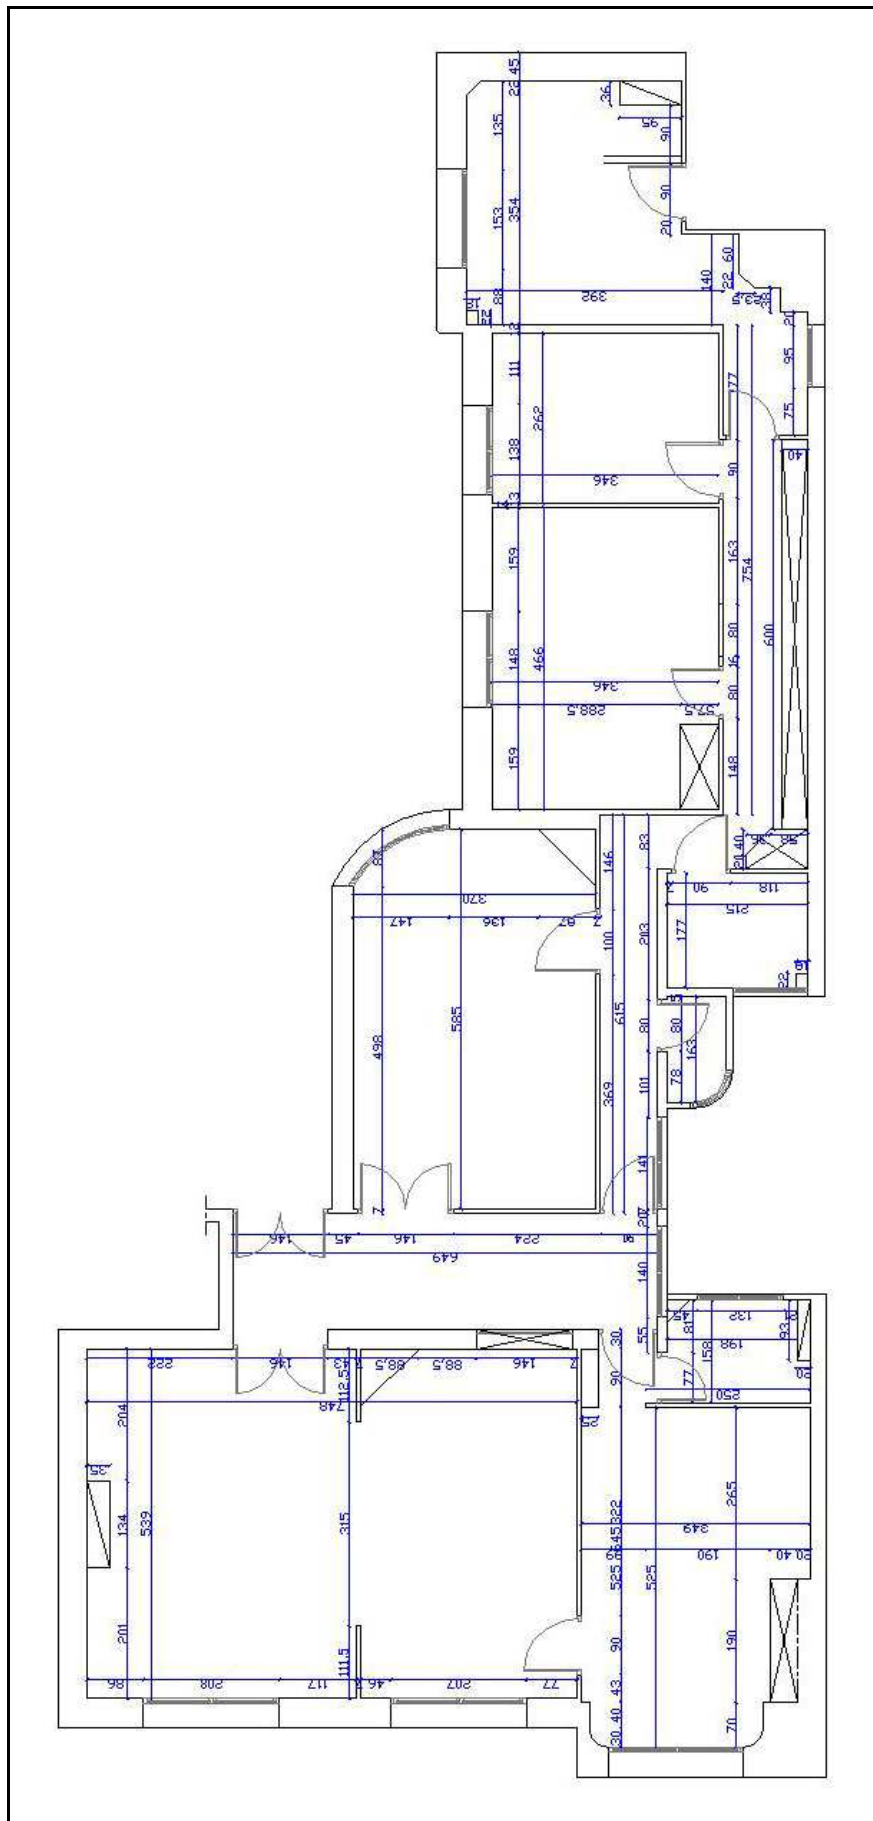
Plan d'état des lieux d'un appartement Haussmannien
